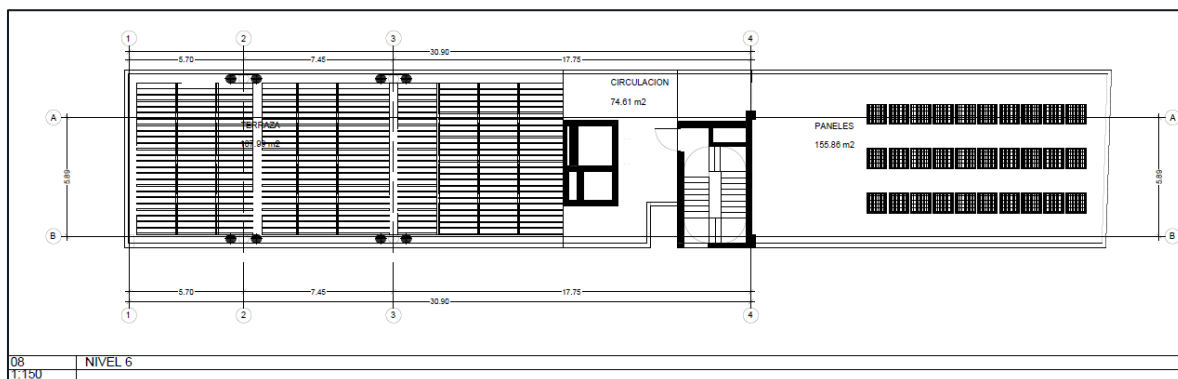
Planta Nivel 6. Fuente: Extracto Plano de Anteproyecto.
